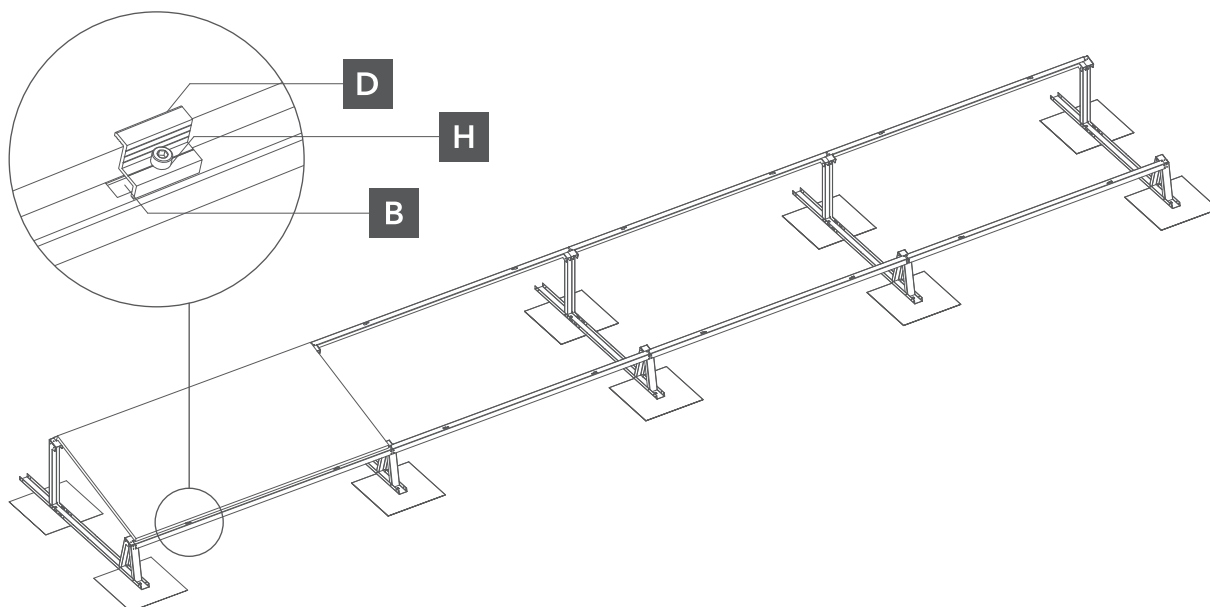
Befestigung der Module an der Halterung des Montagedreiecks.
